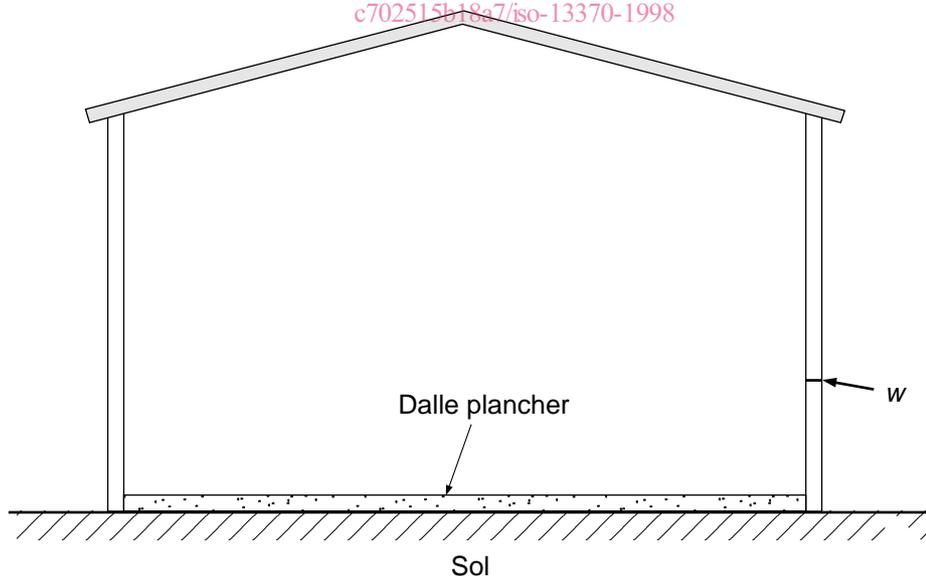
Représentation schématique d'un plancher sur terre-plein
